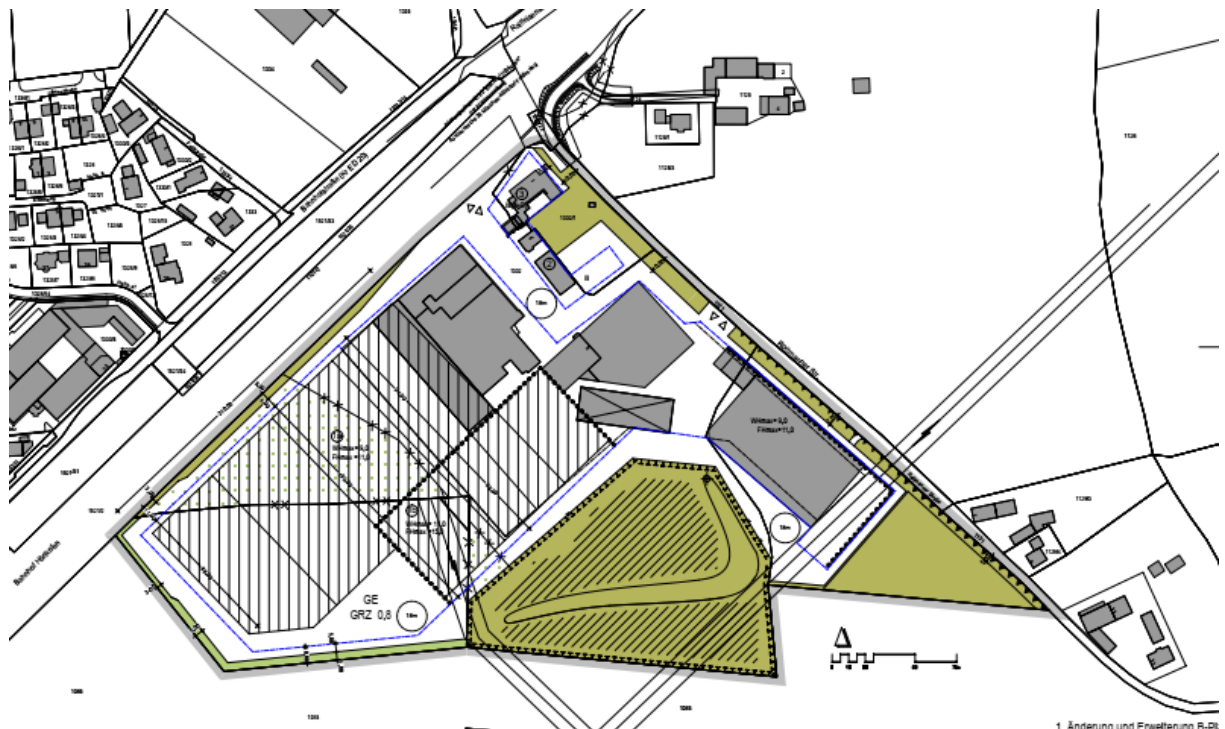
Bebauungsplan Gewerbegebiet Hörlkofen, ehemalige Ziegelei i. d. F. d. 1. Änderung – ohne Maßstab
